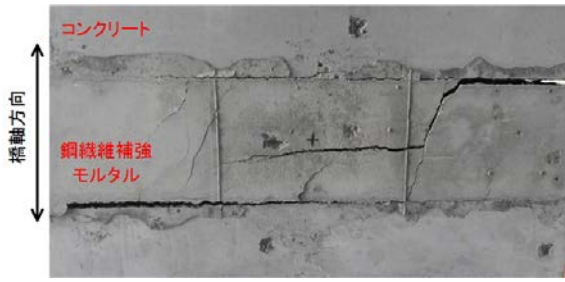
Type3 の試験体の接合部下面のひび割れ状況
